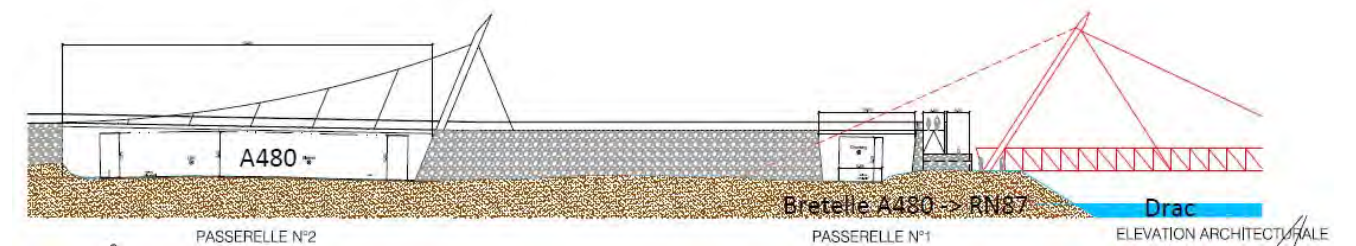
Coupe des passerelles au dessus de l'A480 et de la bretelle A480N vers RN87
